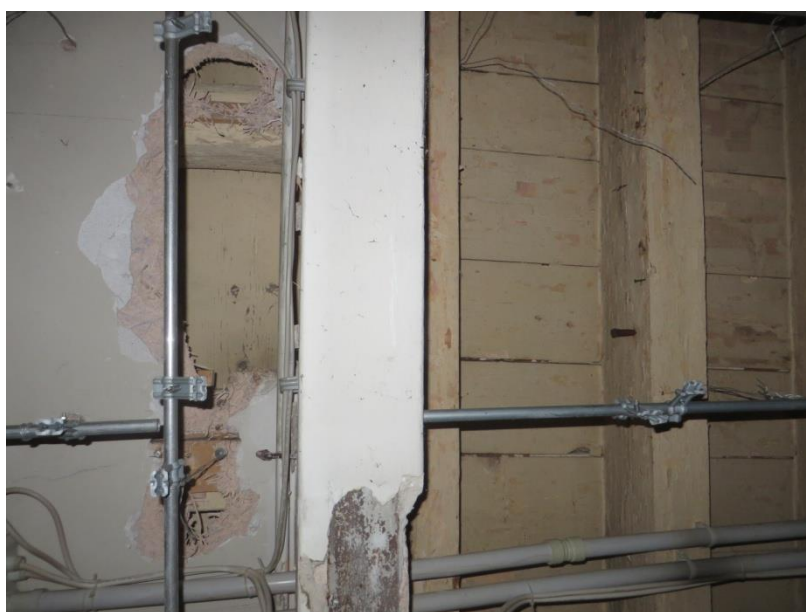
intradosso del solaio a soffitto di T.06.b (a sinistra) e del solaio a soffitto di T.06.c (a destra), separati dalla trave IPE200 che funge da appoggio per le travi del solaio T.06.b
